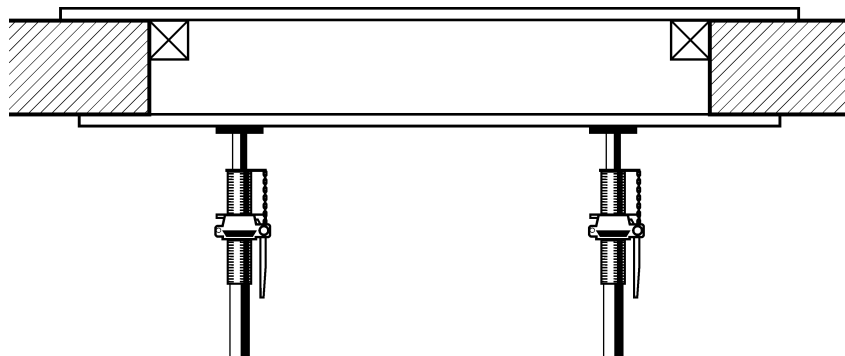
Copertura delle aperture praticate sul pavimento, suolo o nel solaio
